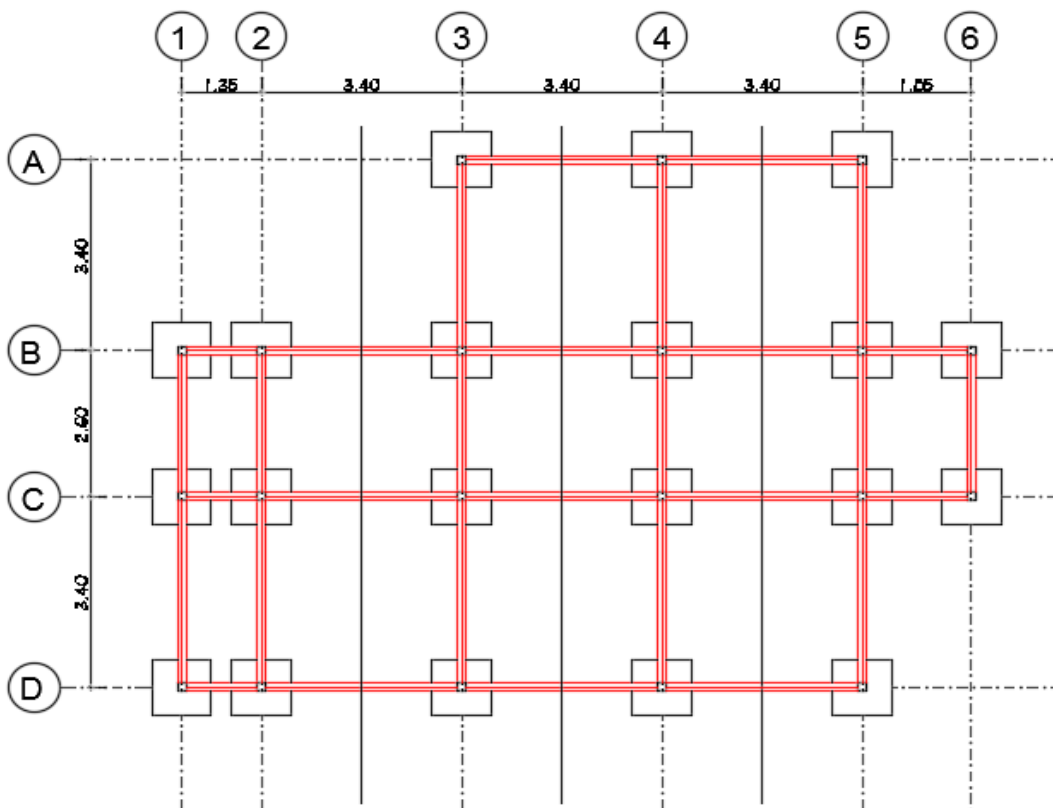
Planta de Columnas, Área Cooperante Columna "C2".
